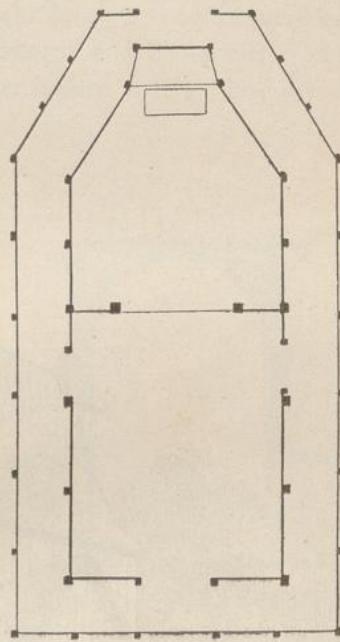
Grundriss der Kirche zu Braunau.
